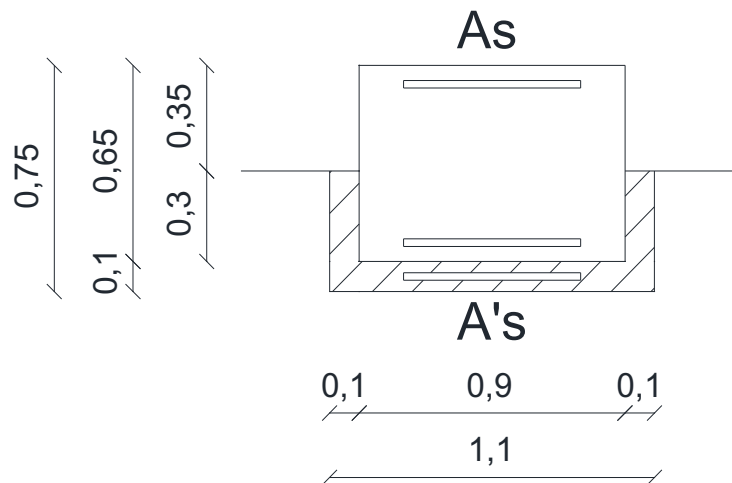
Sezione trasversale di tutte le travi presenti nella struttura.
